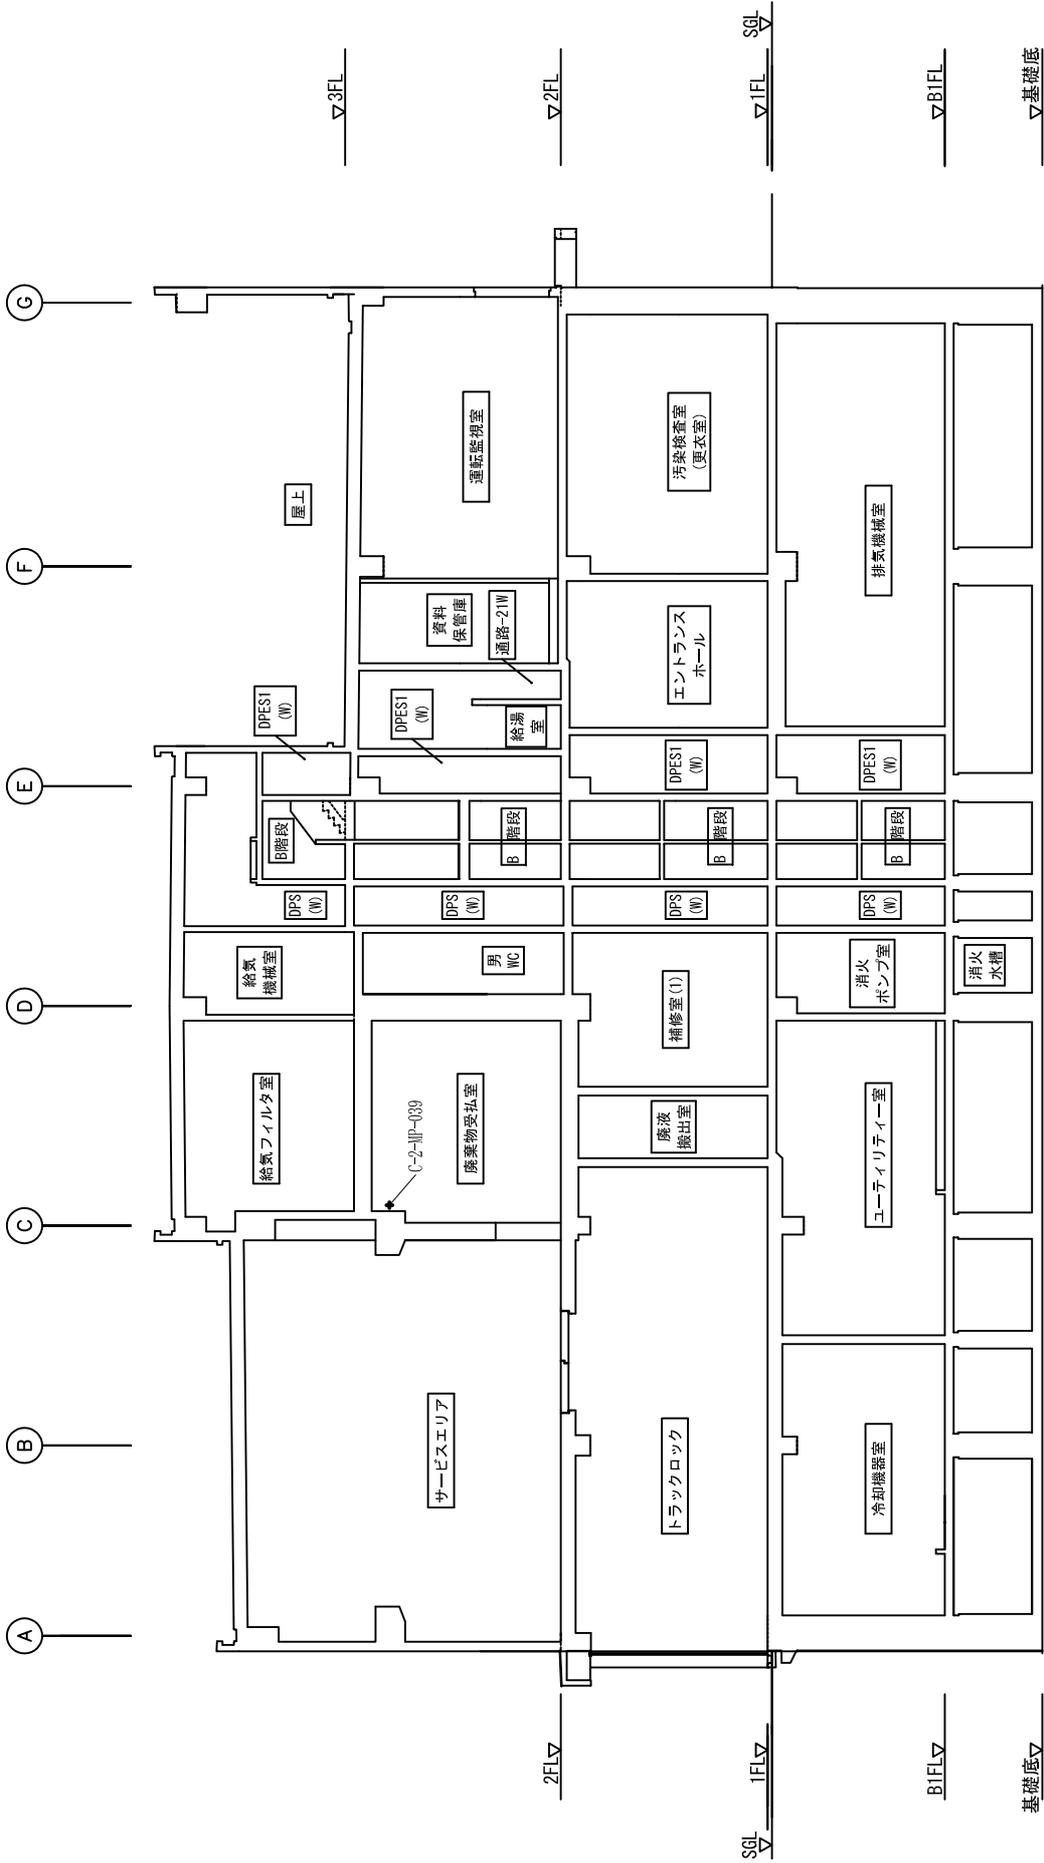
室内空気モニタ及びロボットサンプリング装置の配管類 (埋設部) 配置図 (②~③間断面図)
